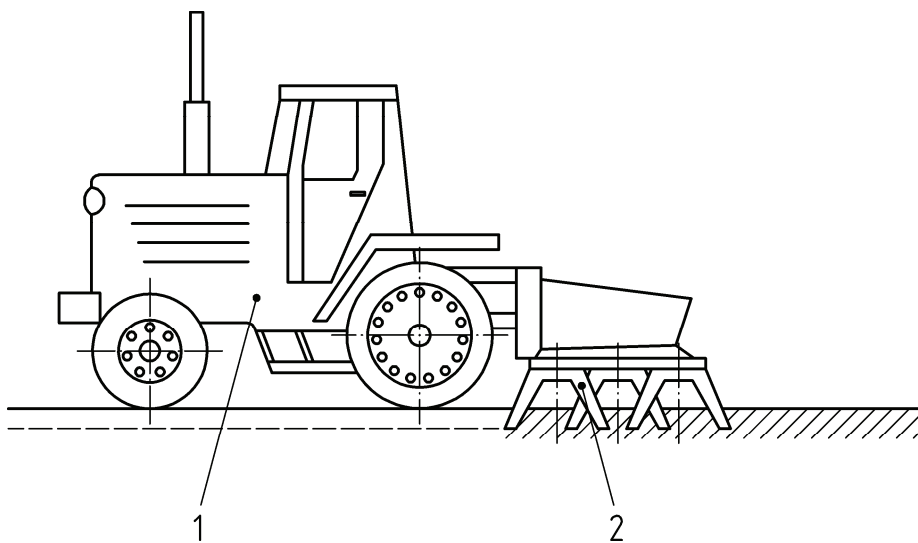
Heck-Bodenstabilisierungsmaschine mit horizontalem Rotor
